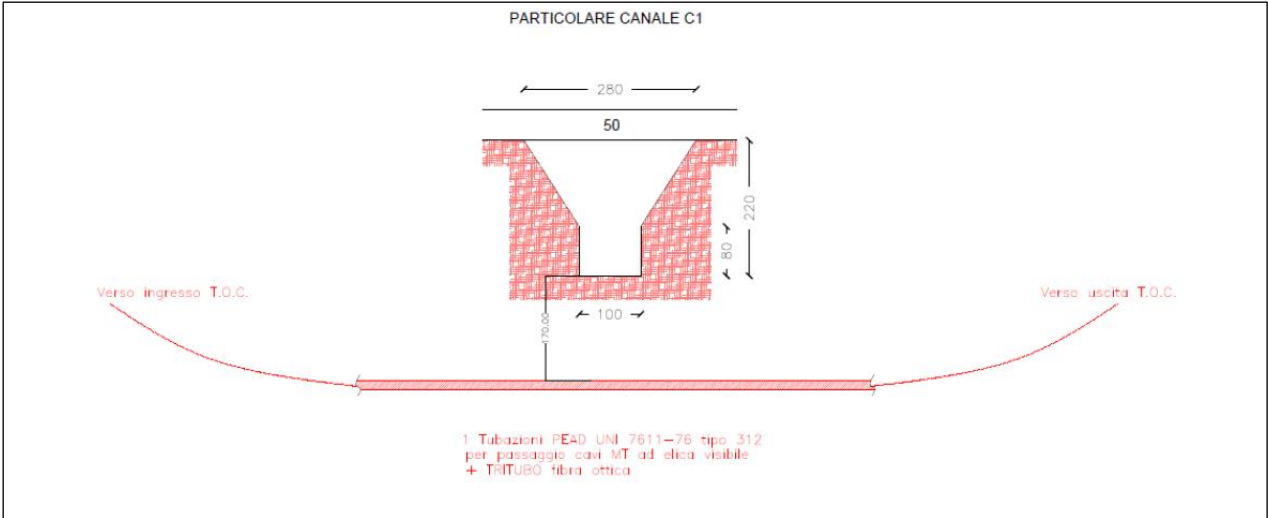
Dettaglio attraversamento in T.O.C. canale C1
